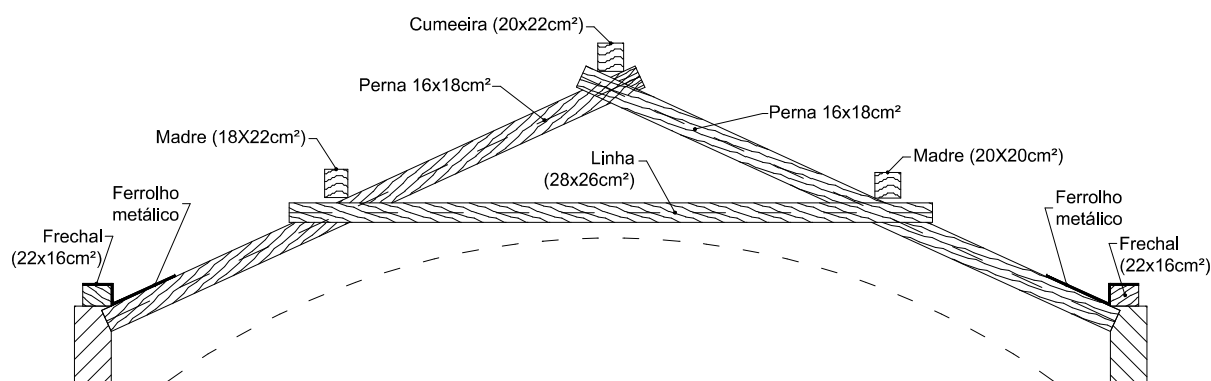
Alçado tipo das asnas da nave (sem escala).
